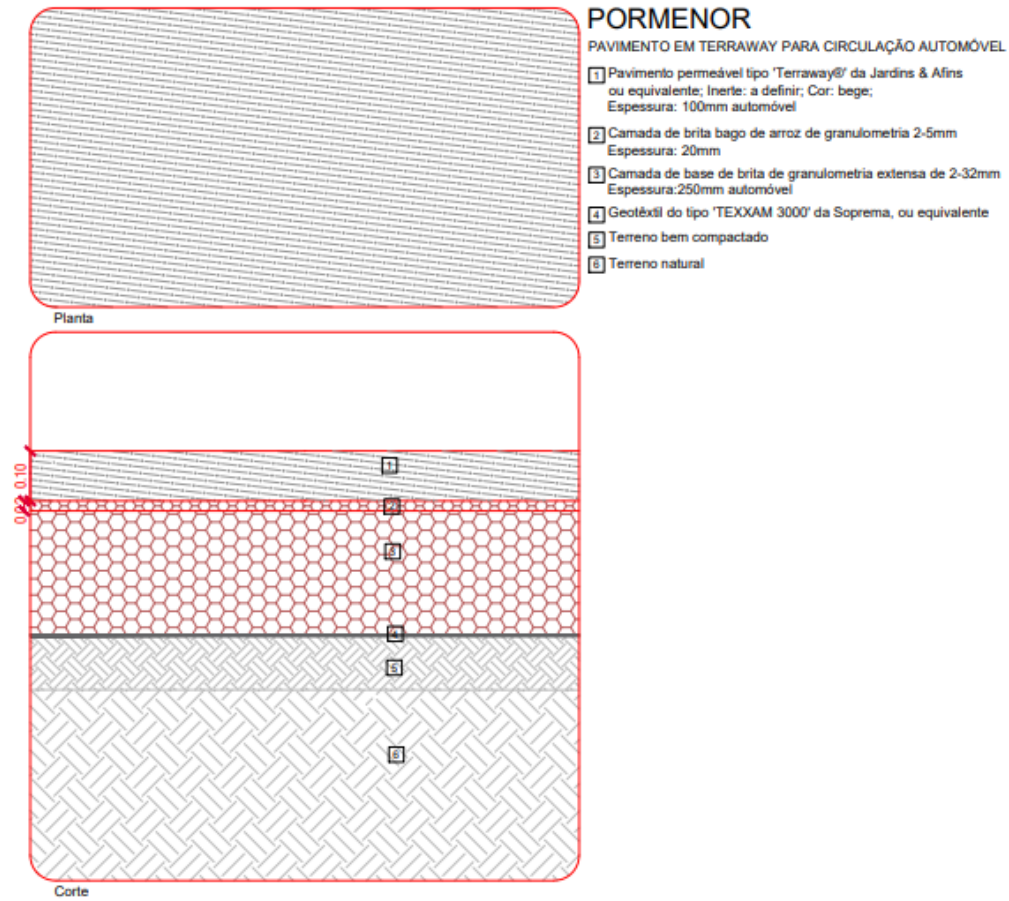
Corte, pormenor de construção de um pavimento em resina permeável. Fonte: LG – Group. Empresa de arquitetura paisagista.
